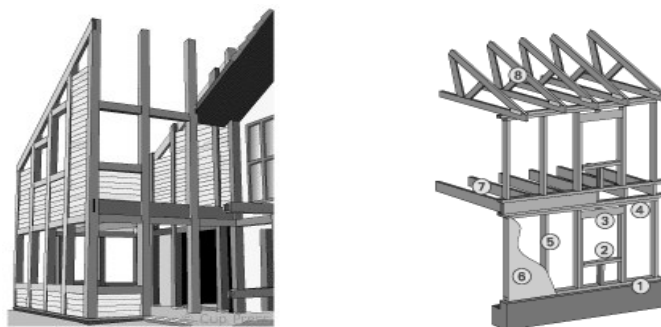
Techniques « poteau poutres » et « ossature bois »
